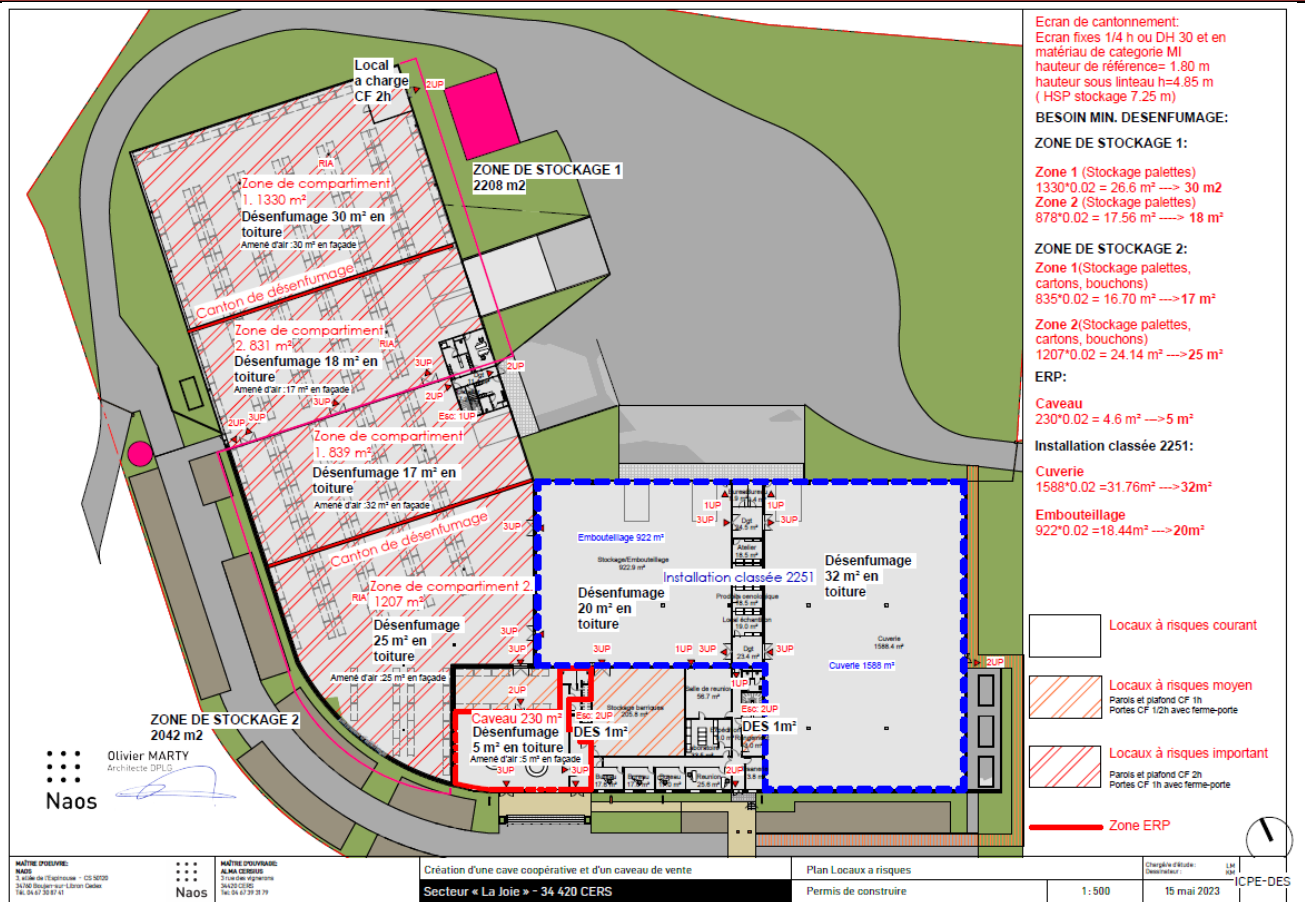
Plan des locaux à risque incendie (Source : NAOS Architecte)
